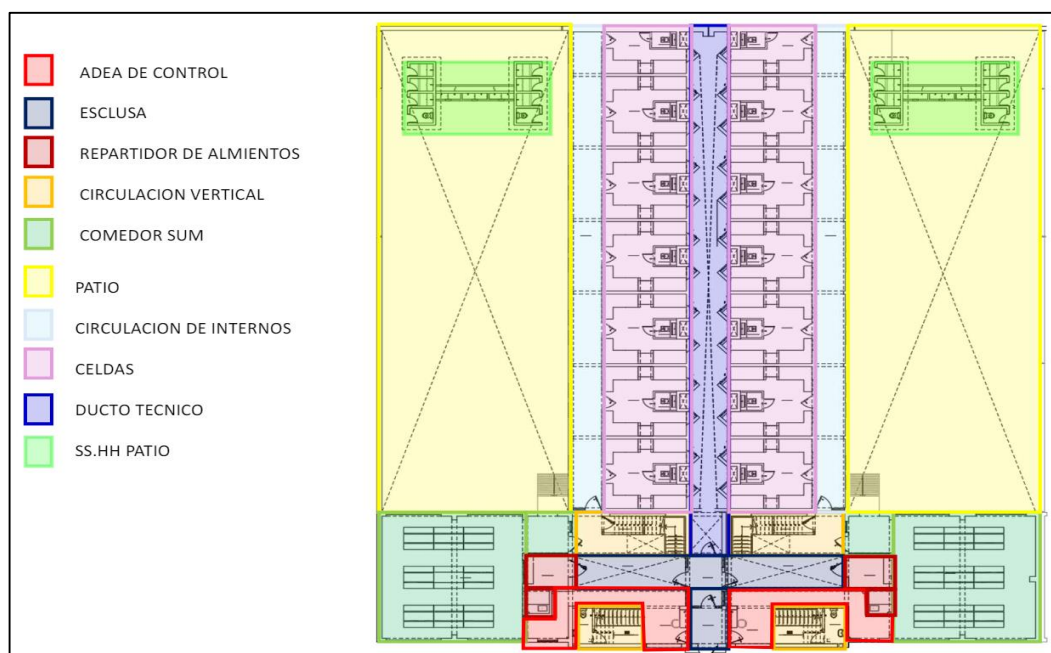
Planta 1er piso del pabellón mínima - Varones
